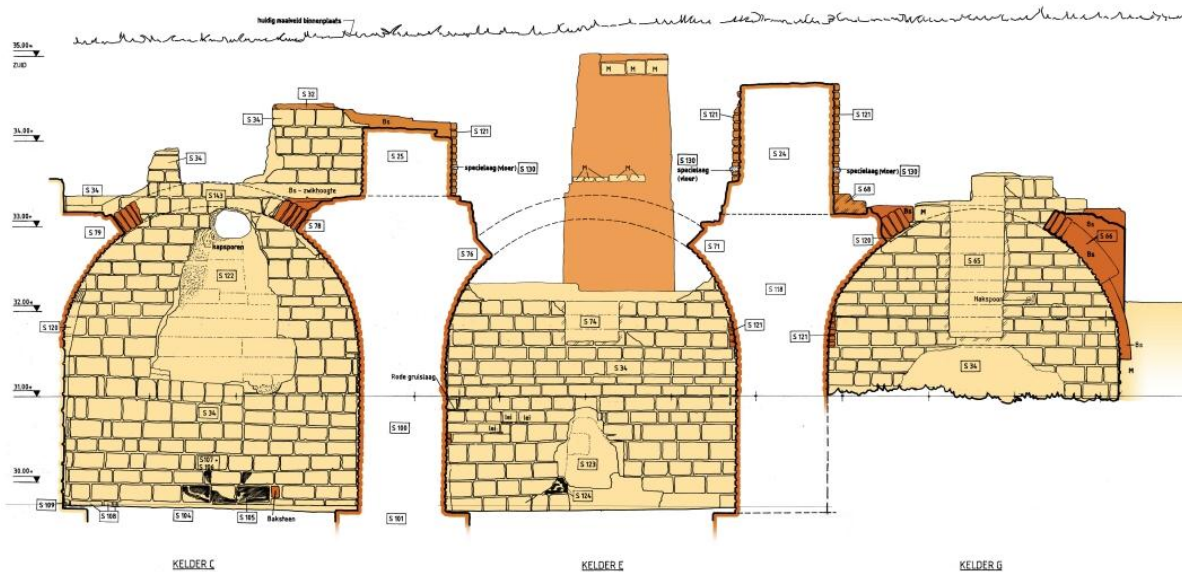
Vullagen westzijde (profiel 004, detail uit tekening 07, bijlage 2).
